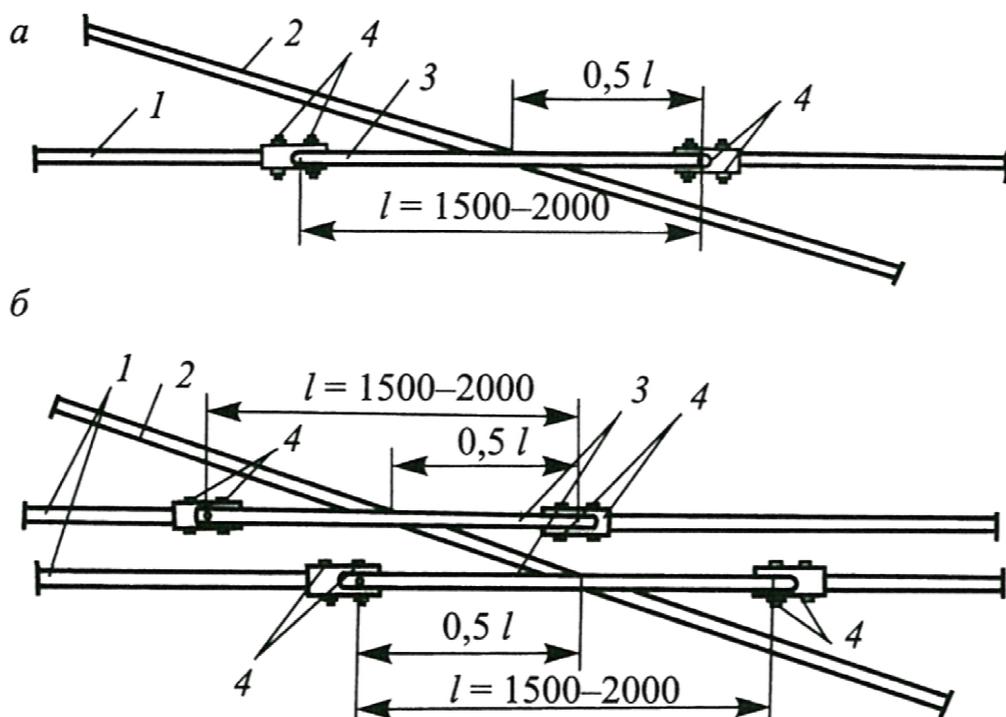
Ограничительная накладка: *а* — при пересечении одинарных проводов; *б* — при пересечении одинарного контактного провода с двойным; 1 — контактный провод прямого пути; 2 — то же съезда; 3 — ограничительная накладка; 4 — головка болта фиксирующего зажима
